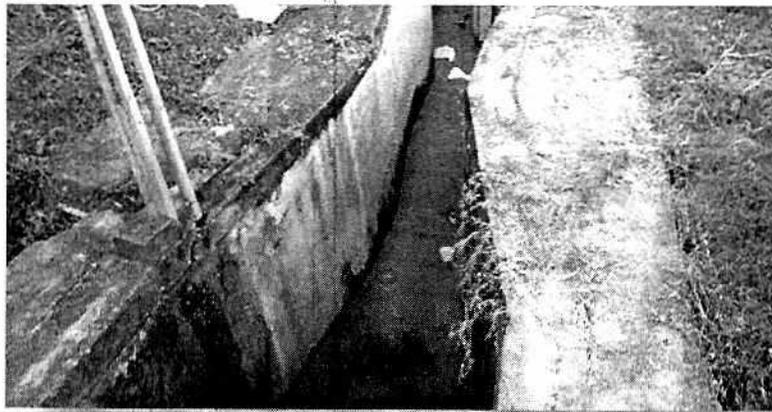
Estructura de control de caudal (Canaleta Parshall)
